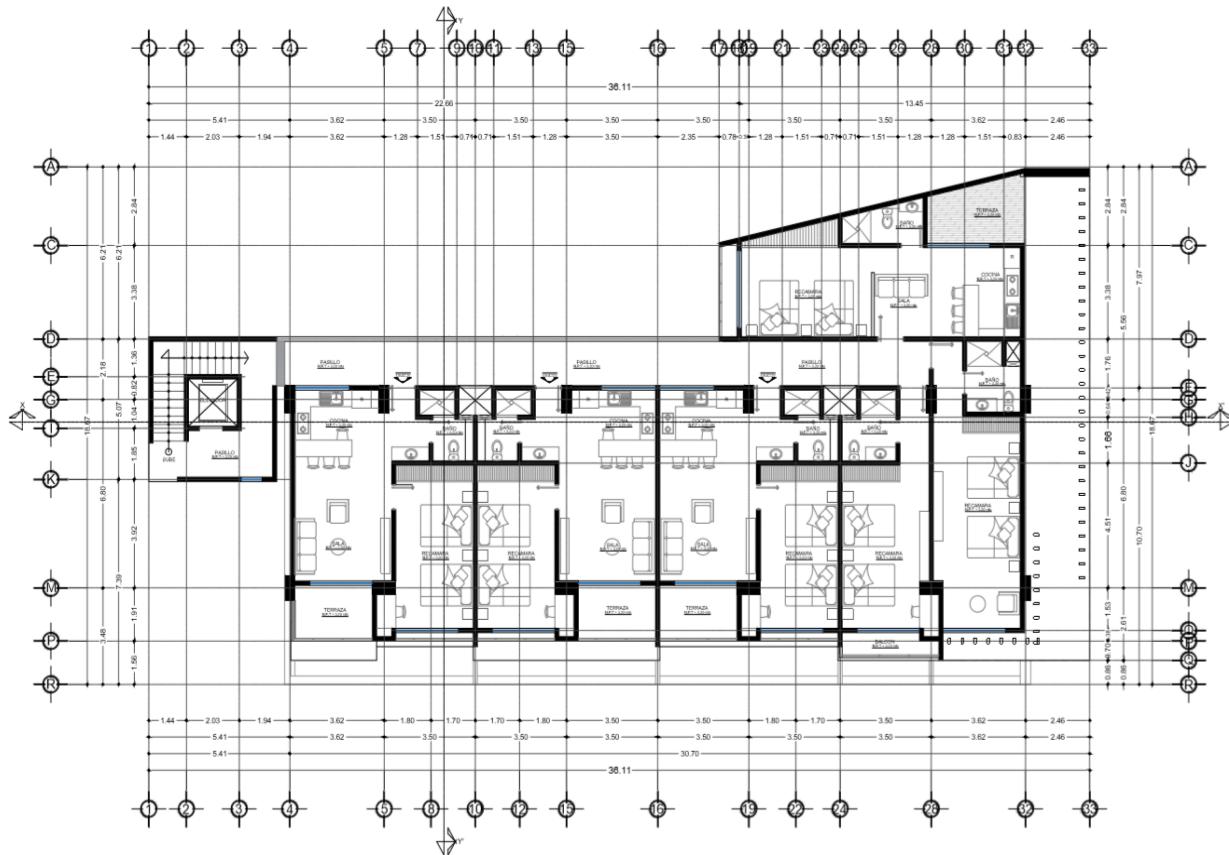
Planta arquitectónica del primer nivel del Edificio B.
